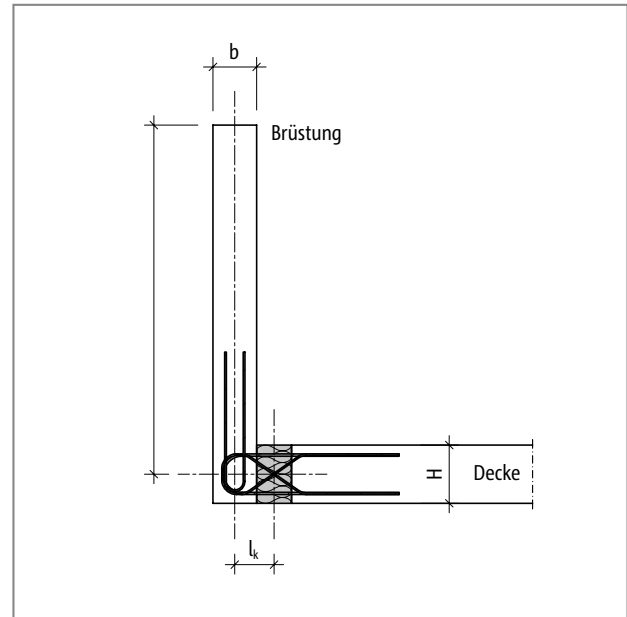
Schöck Isokorb® XT Typ F: Statisches System
